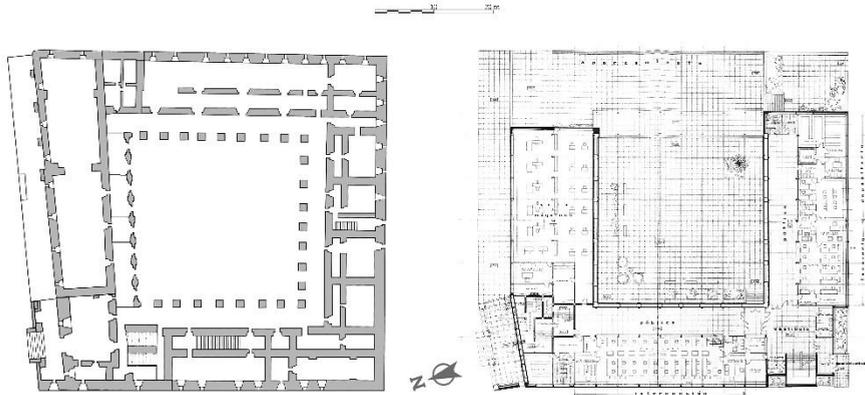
Planta baja del estado previo del convento y de la propuesta de Castelao para la Delegación de Hacienda
